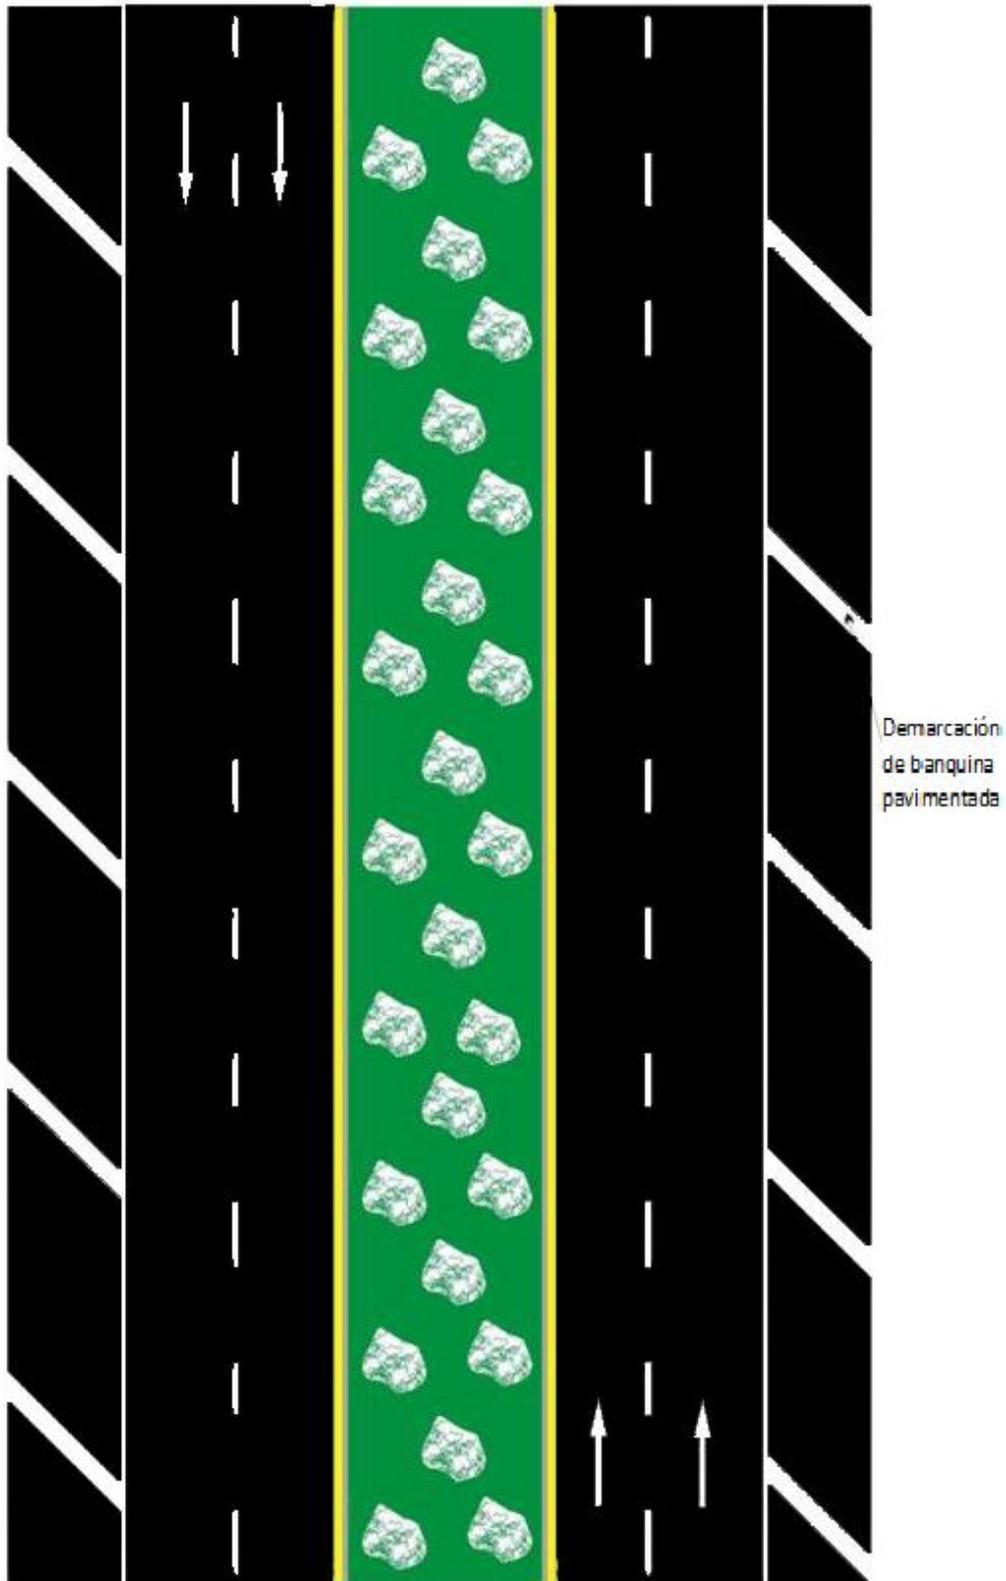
DEMARCACIÓN DE BANQUINAS PAVIMENTADAS
